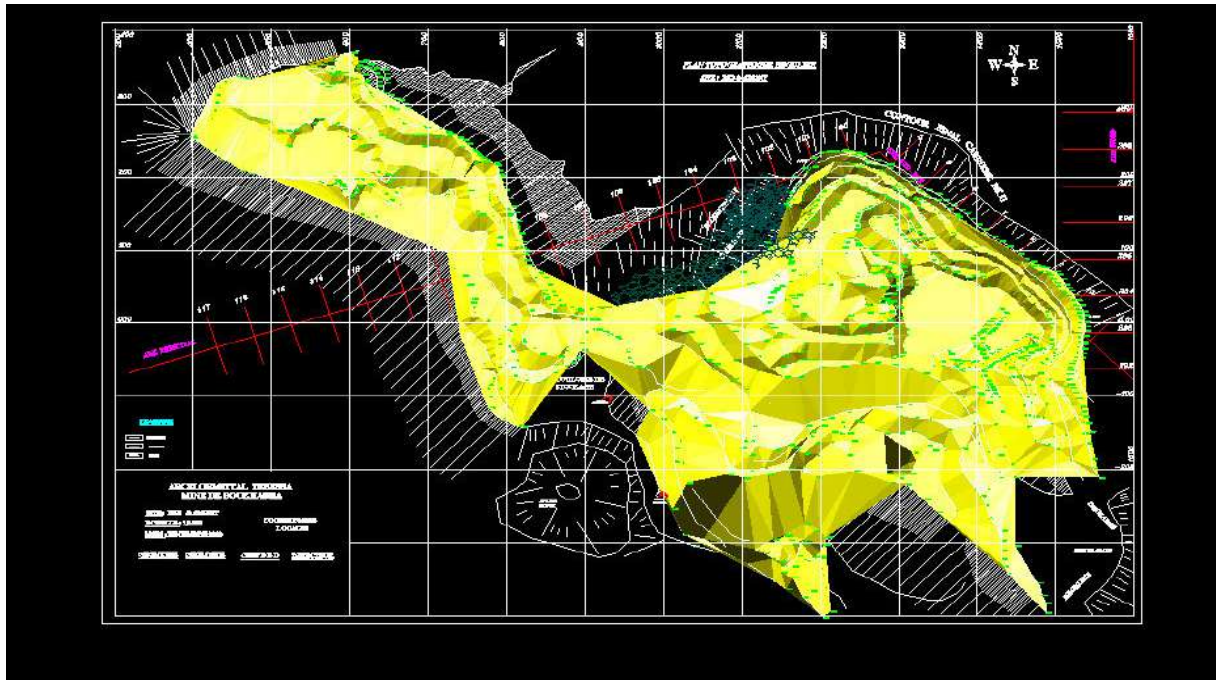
Plan topographique de la mine de Boukhadra. [1]
